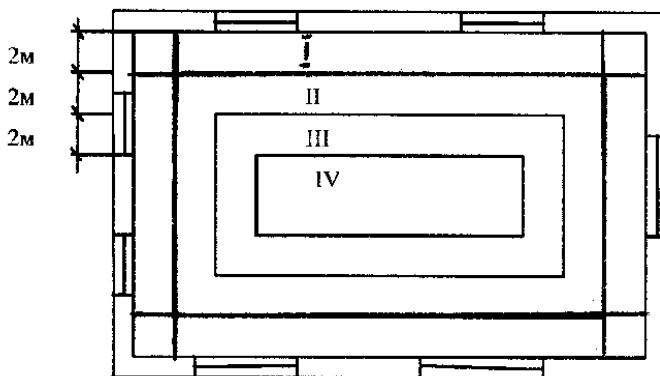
Схема разделения площади пола на грунте или на лагах на зоны при расчете теплопотерь
